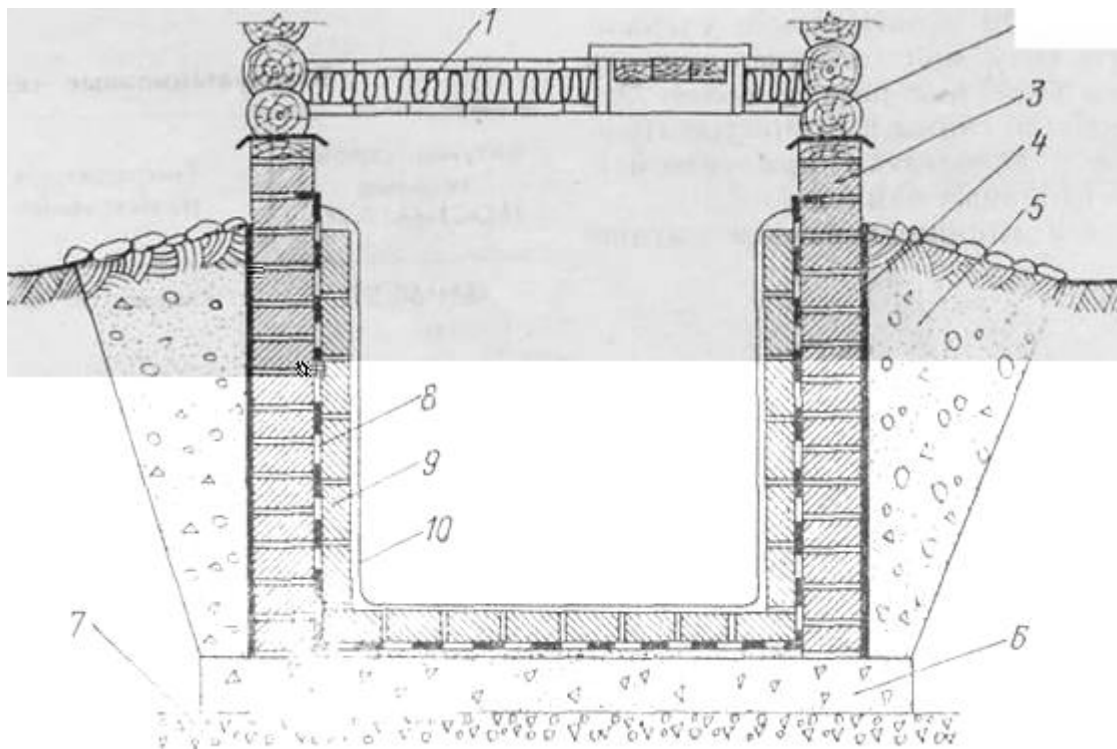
Гидроизоляция со стороны погреба: 1 – перекрытие погреба; 2 – деревянный сруб; 3 – кирпичная стенка погреба; 4 – обмазки битумной мастикой; 5 – засыпке пазух; 6 – бетонное основание; 7 – подготовка из утрамбованного щебня; 8 – оклеечная противонапорная гидроизоляция; 9 – защитная стенка; 10 – цементная штукатурке
